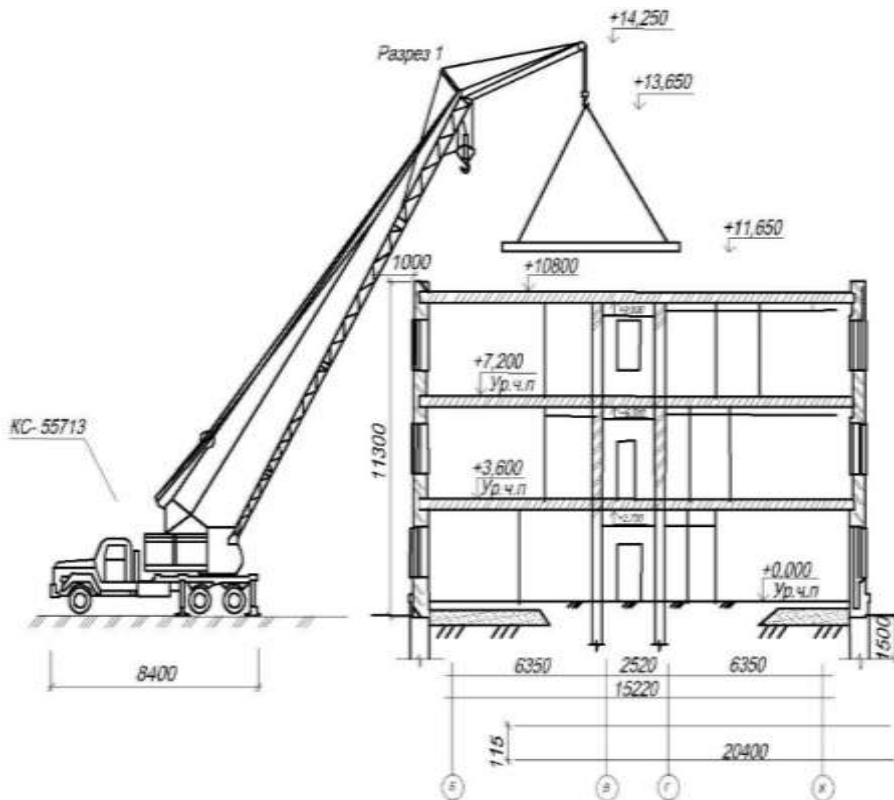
Фрагмент монтажа плит перекрытия при дифференцированном методе
